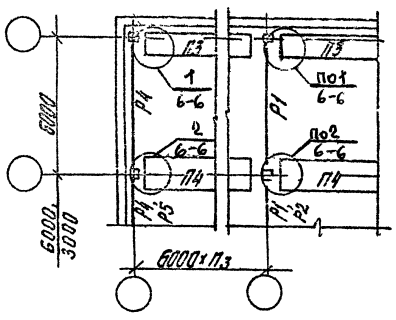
Схема расположения ригелей и связей плит в перекрытиях зданий с сеткой колонн 6х6 м и (6+3+6)х6 м
